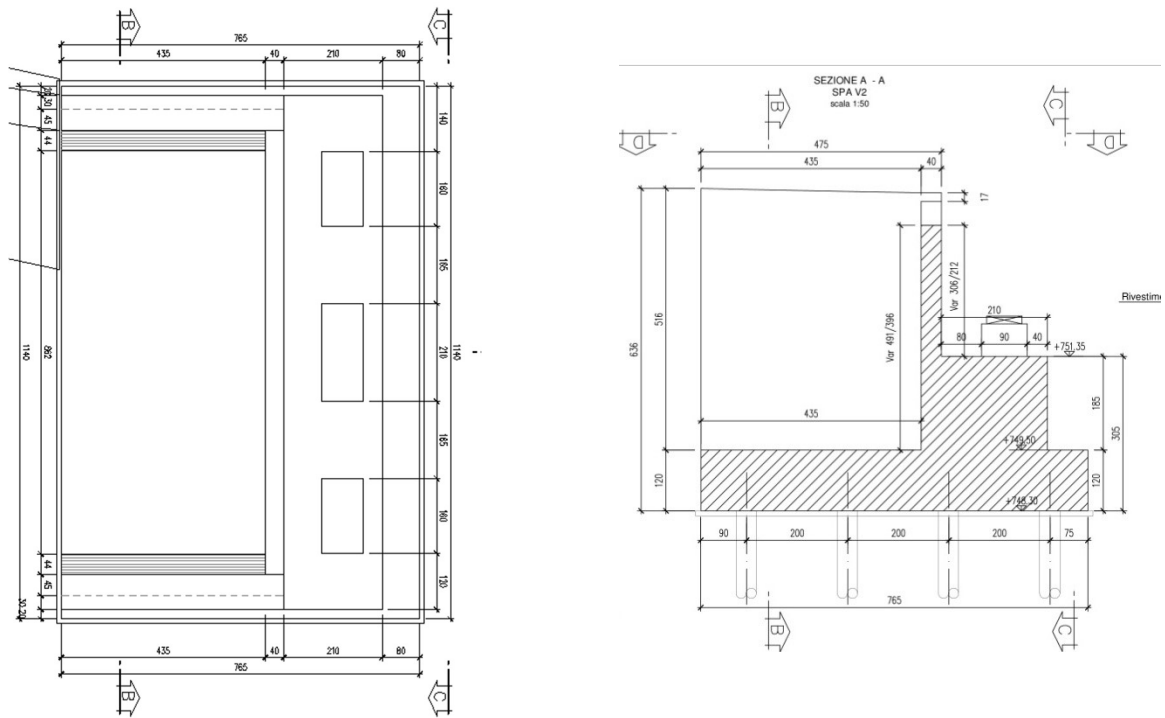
Spalla A: sezione longitudinale e pianta
